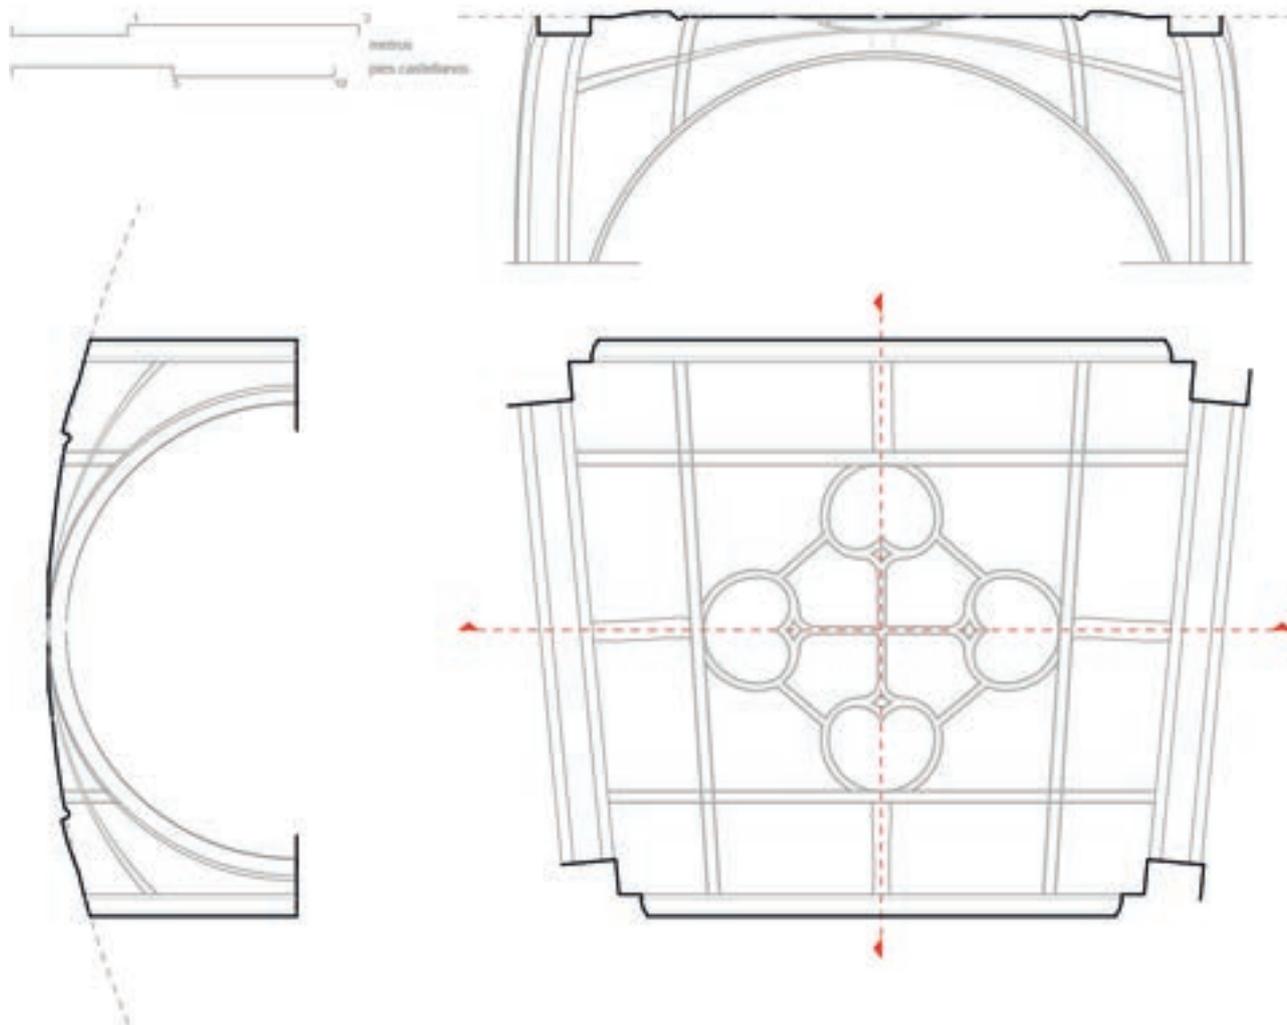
Bóveda de la girola de la catedral de Granada. Planta, sección transversal y sección longitudinal. D. de Siloé, c. 1540. Levantamiento de R. Senent
